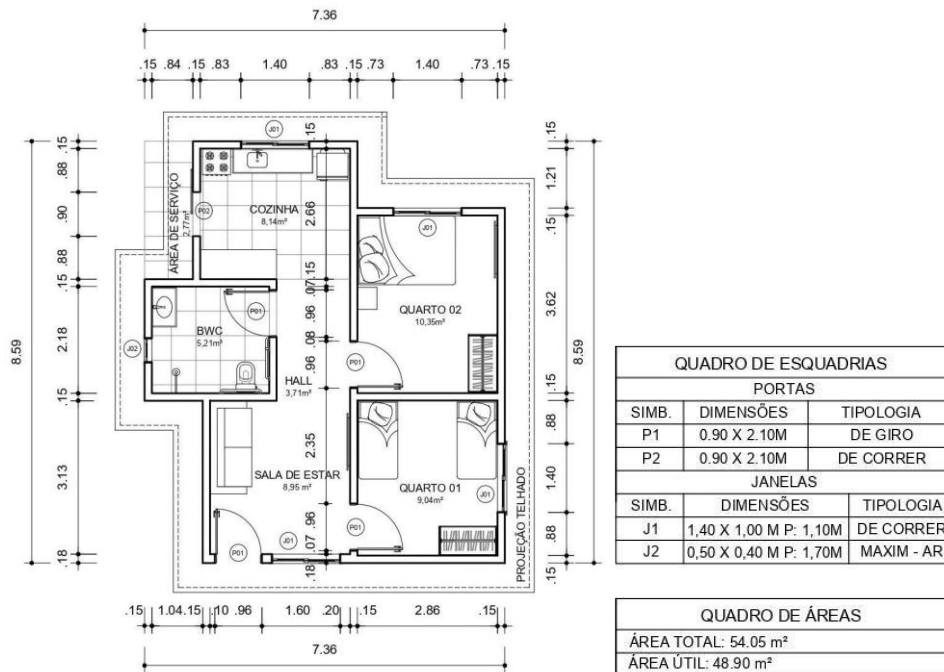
Planta baixa demolir-construir do projeto brasileiro Minha Casa, Minha Vida.
